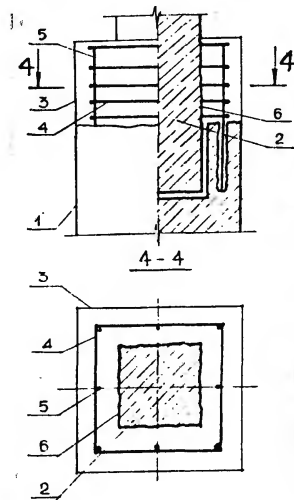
Нарращивание стенок стакана железобетонной облоймой
